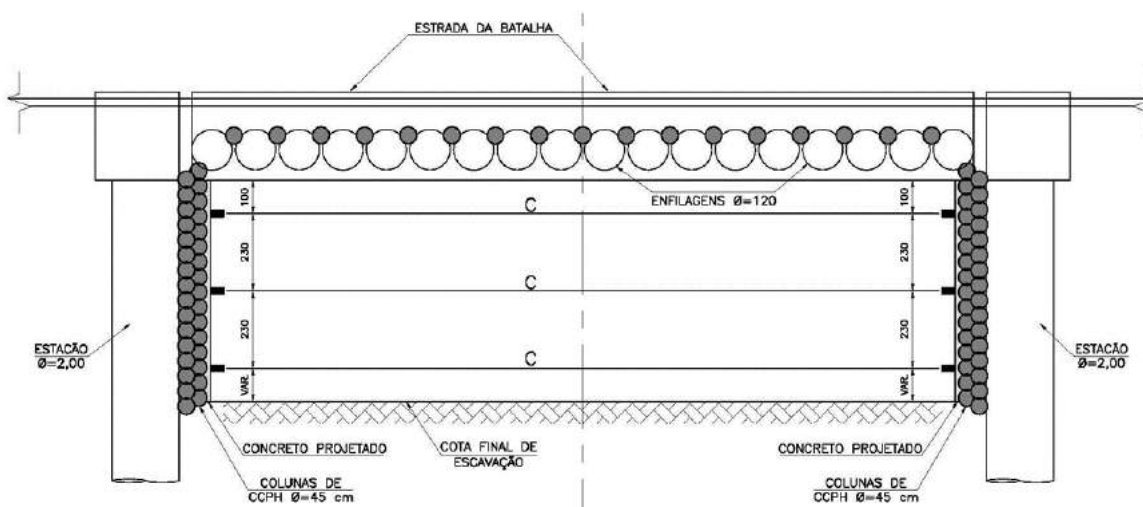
Pré-laje formada com tubos preenchidos com concreto armado - Travessia Estrada da Batalha – Recife, PE (Projeto Maffei, 2009).
